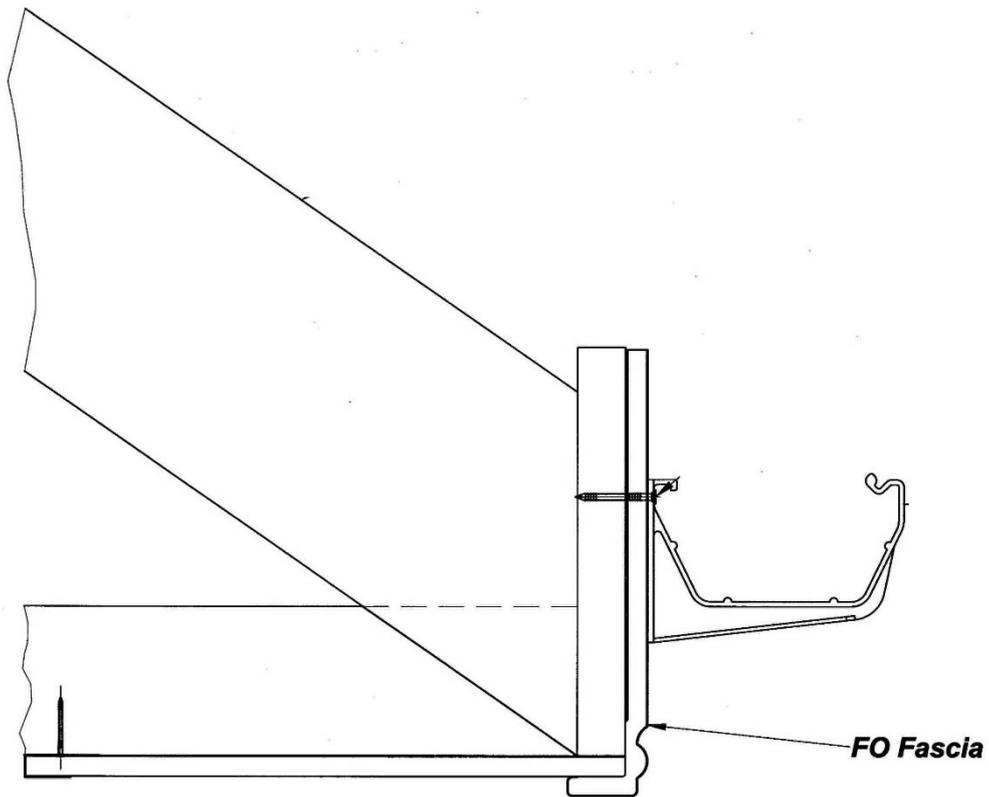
Principe de mise en œuvre de la gouttière sur planche de rive FO
